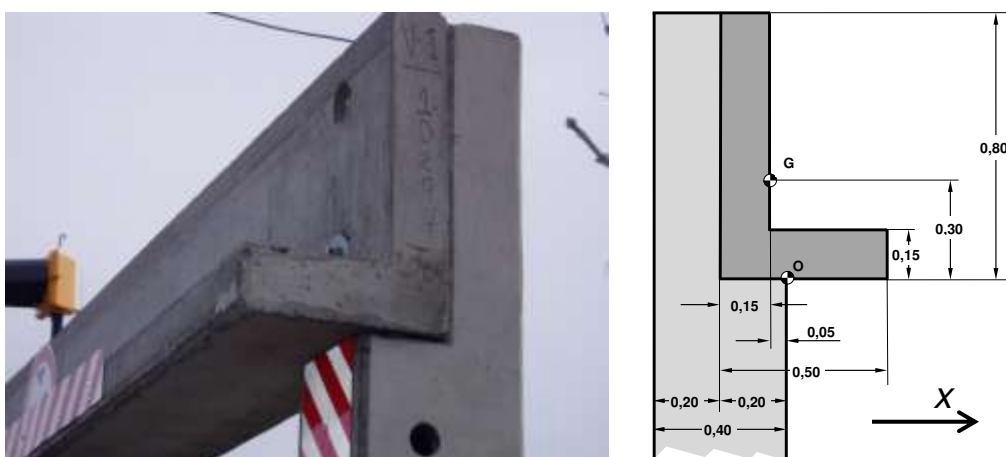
Detalle de la viga y apoyo en columna correspondiente a apoyo extremo y dimensiones en m.
